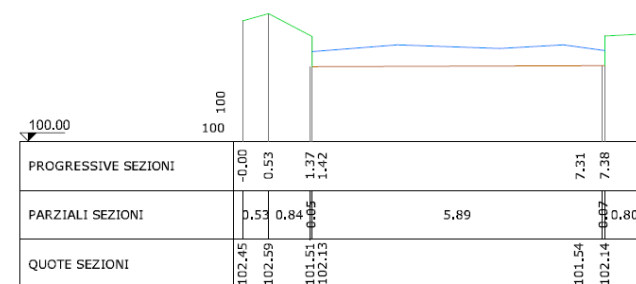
Sezione trasversale T1153 – COLO29 - 647
